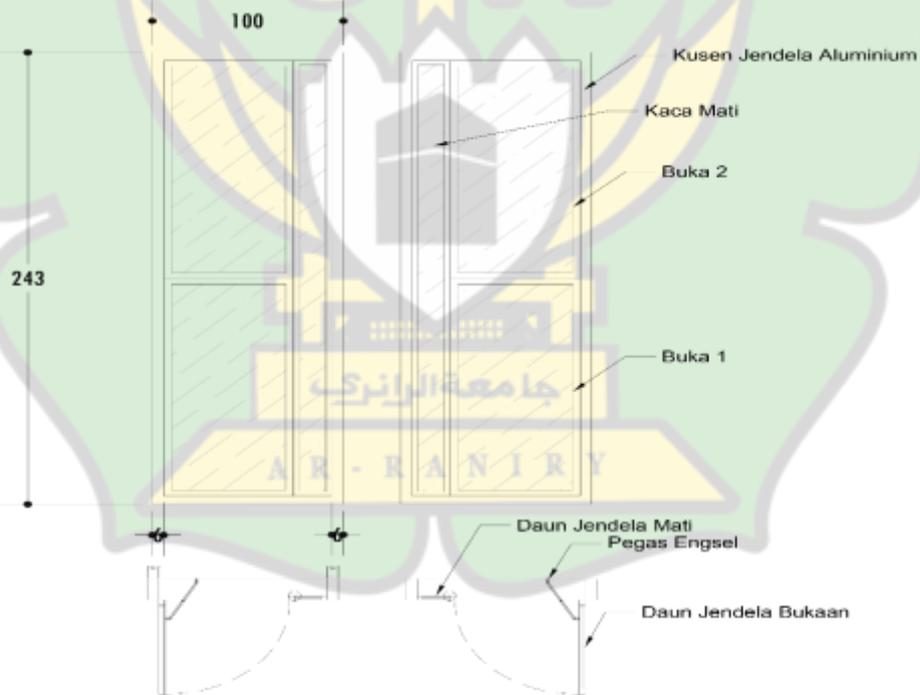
19 Denah Rencana Kusen Asrama Lantai 3
